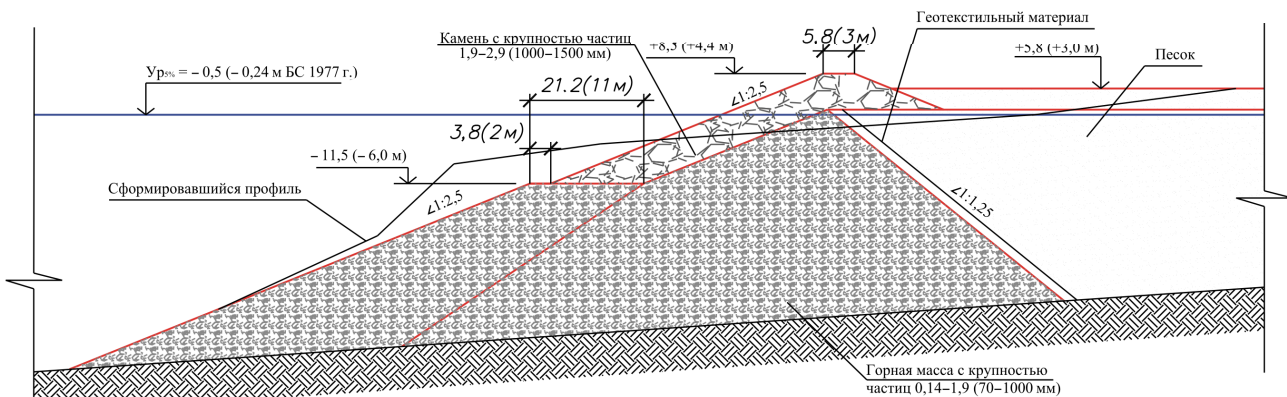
Конструкция № 1. Переформирование откоса на разных участках по окончании опыта
